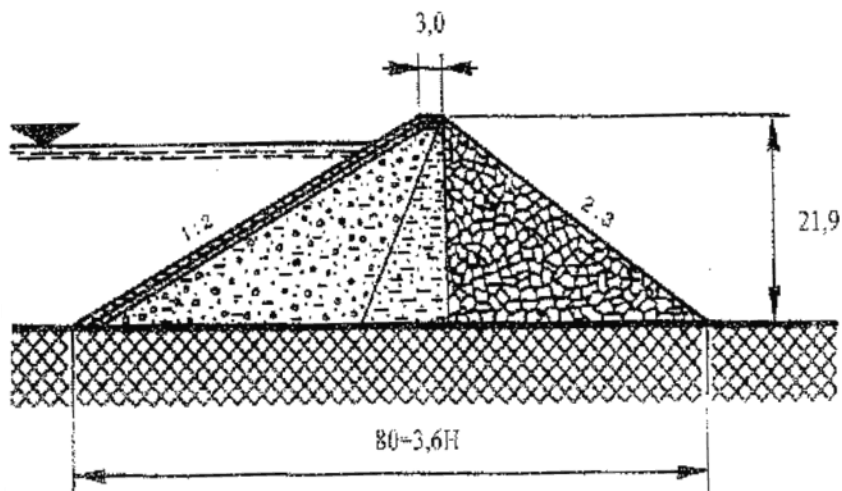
Esquema da secção transversal de uma barragem mista
